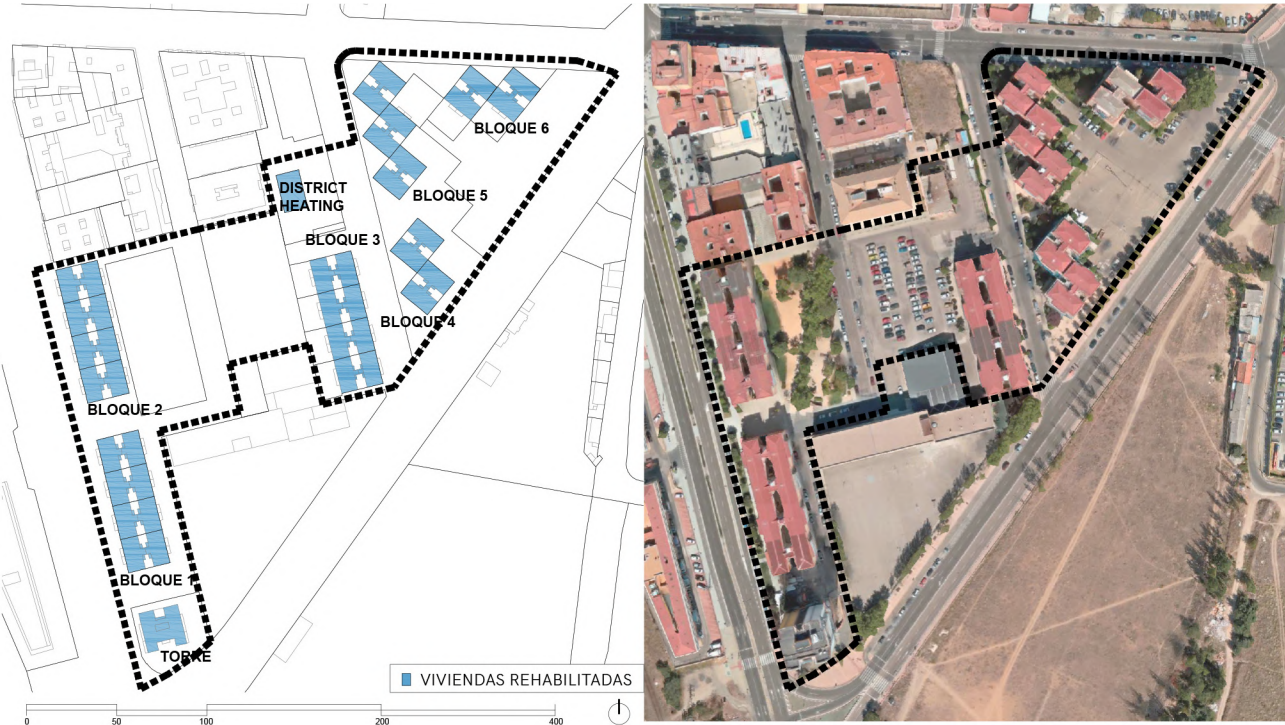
Delimitación del ámbito: Plano de situación y ortofoto
